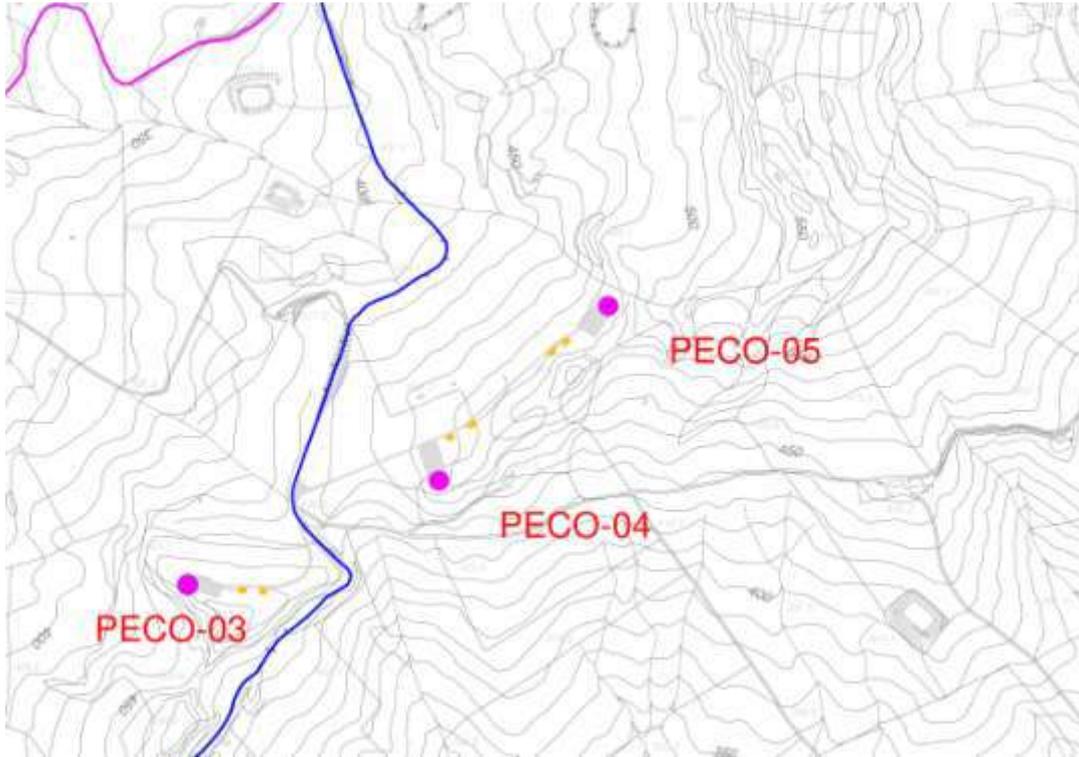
Legenda planimetrie delle strade di cantiere
